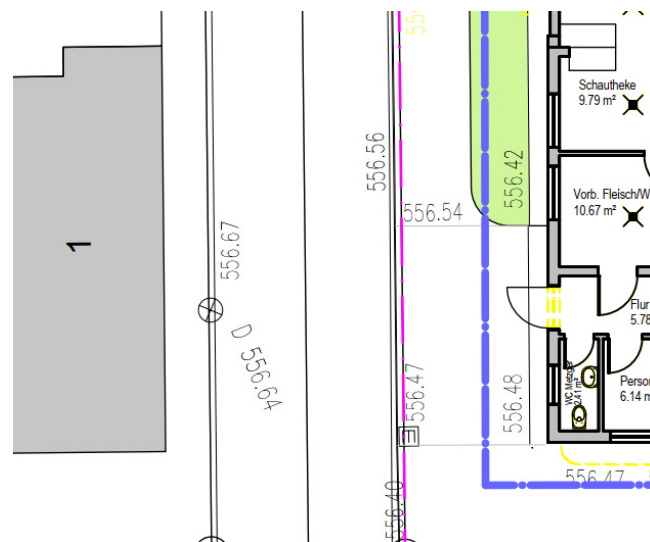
Ausschnitt aus dem Lageplan, jetziger Standort Presscontainer anstelle des südlichsten Pkw-Stellplatz an der Ostfassade im Bereich des Lagers aufgestellt
